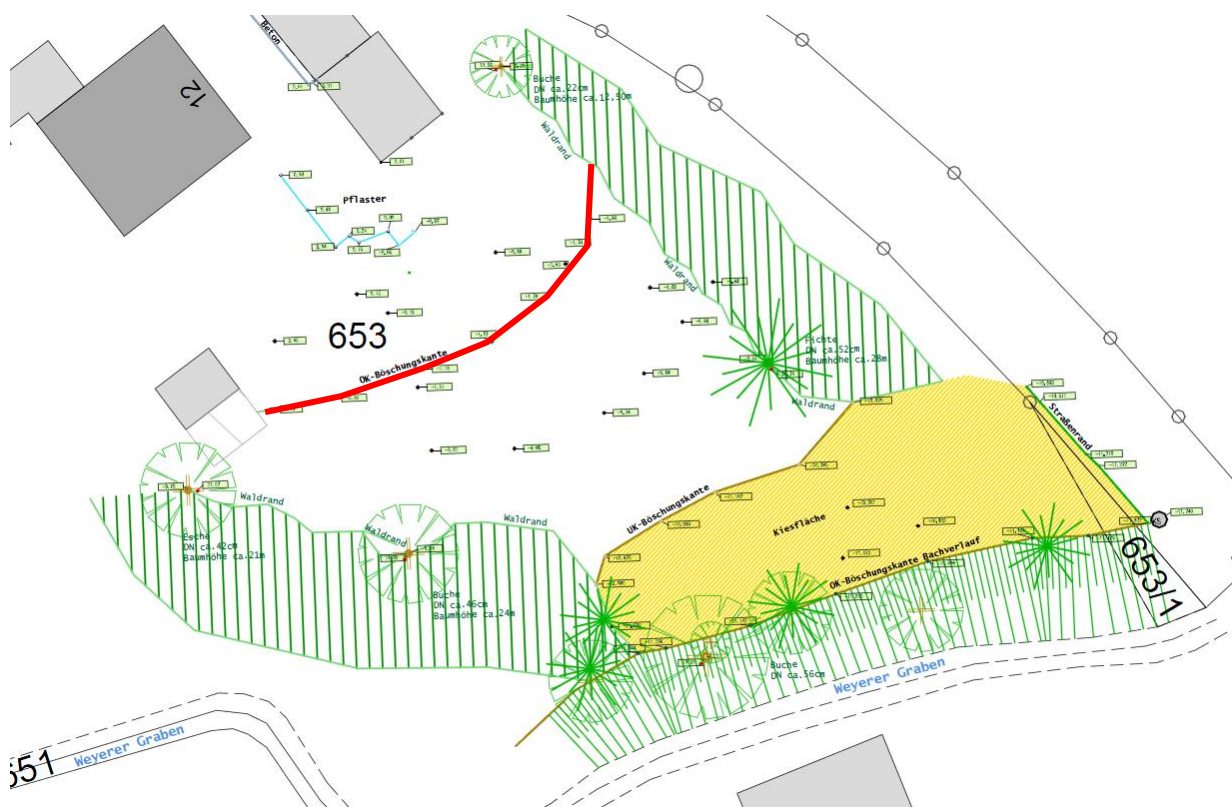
Bestandsaufmaß, Grossmann Bau GmbH & Co. KG, Rosenheim v. 07.07.2021, Waldrand grün schraffiert, Böschungsoberkante rot hervorgehoben
